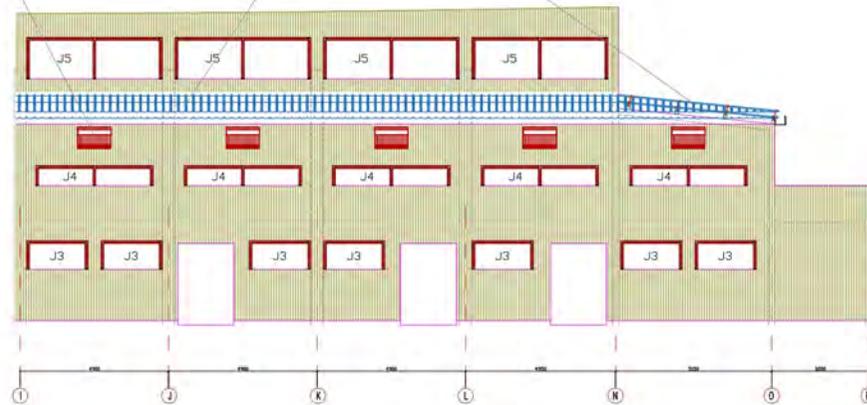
éléments techniques des gîtes de compensation en façade sud, partie droite
